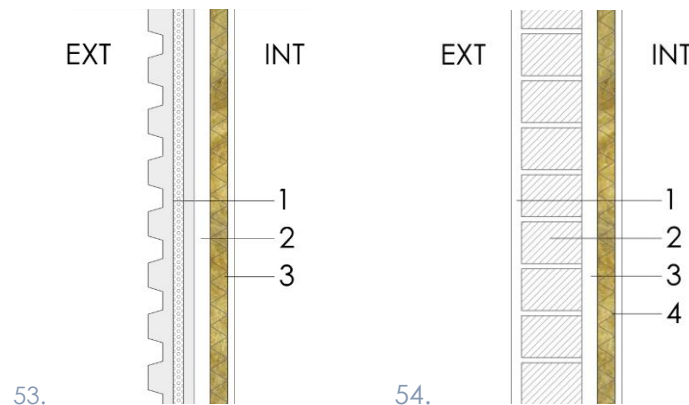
y 54. Detalles de envolvente Tipo 1 y Tipo 2 (secciones verticales) con lana mineral en Málaga. Fuente: Elaboración propia
